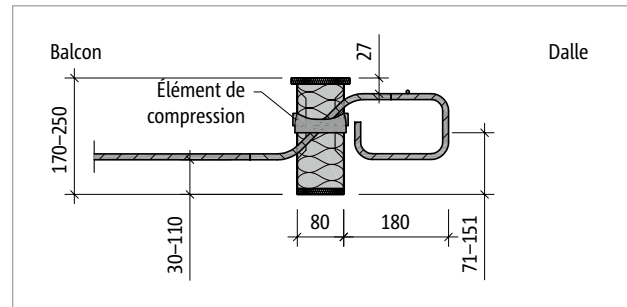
Schöck Isokorb® T Type Q-E-W-V5 : Coupe du produit
